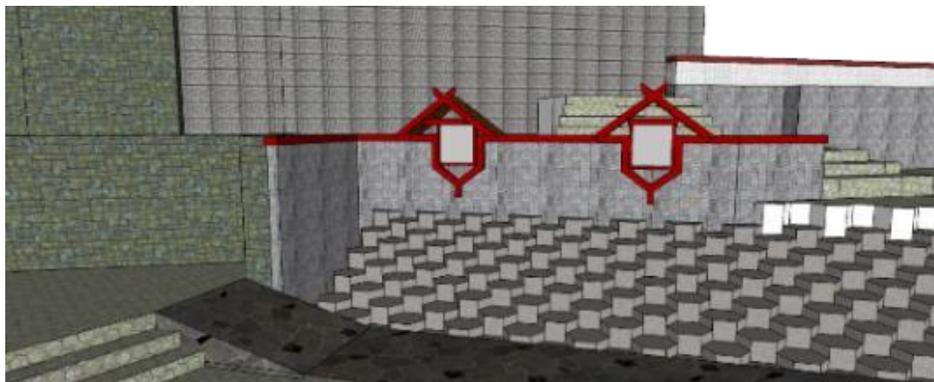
Gubahan Ruang Segmen 1 Jalan Salib
